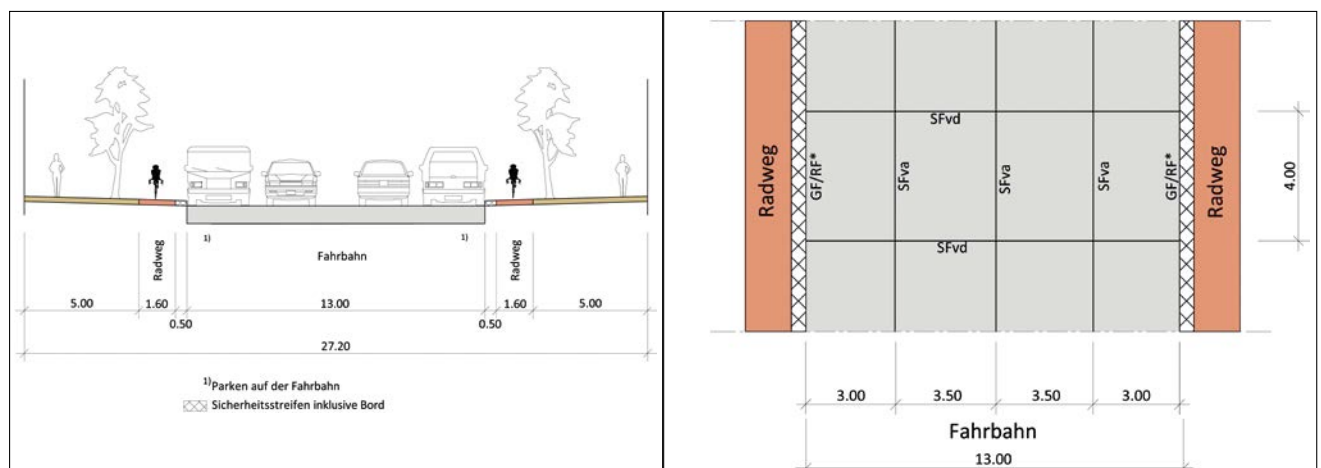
Beispiel einer Industriestraße Typ 10.2 nach RAST
